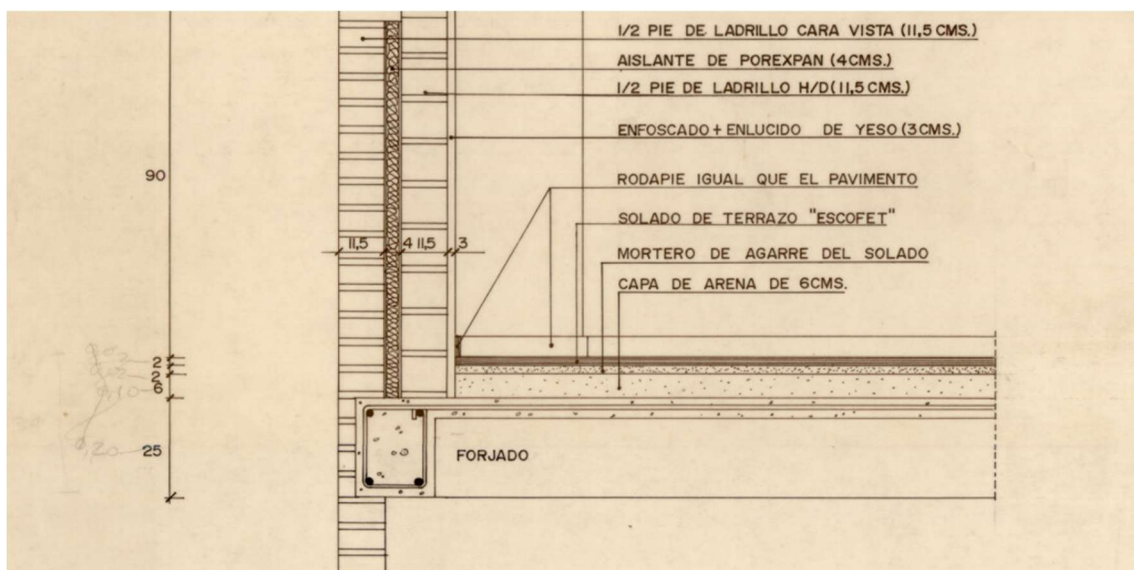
DETALLE ENCUESTRO FACHADA CEIP INFANTA ELENA Y CRISTINA
